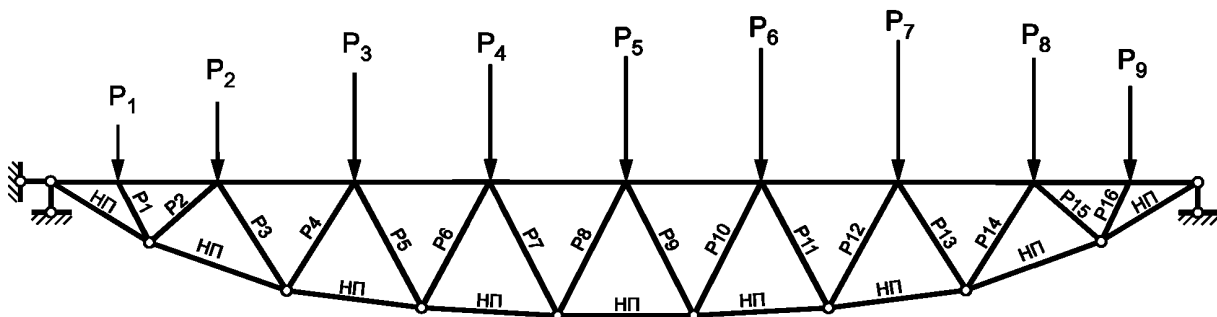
Расчетная схема деревометаллической фермы покрытия Крытого конькобежного центра
